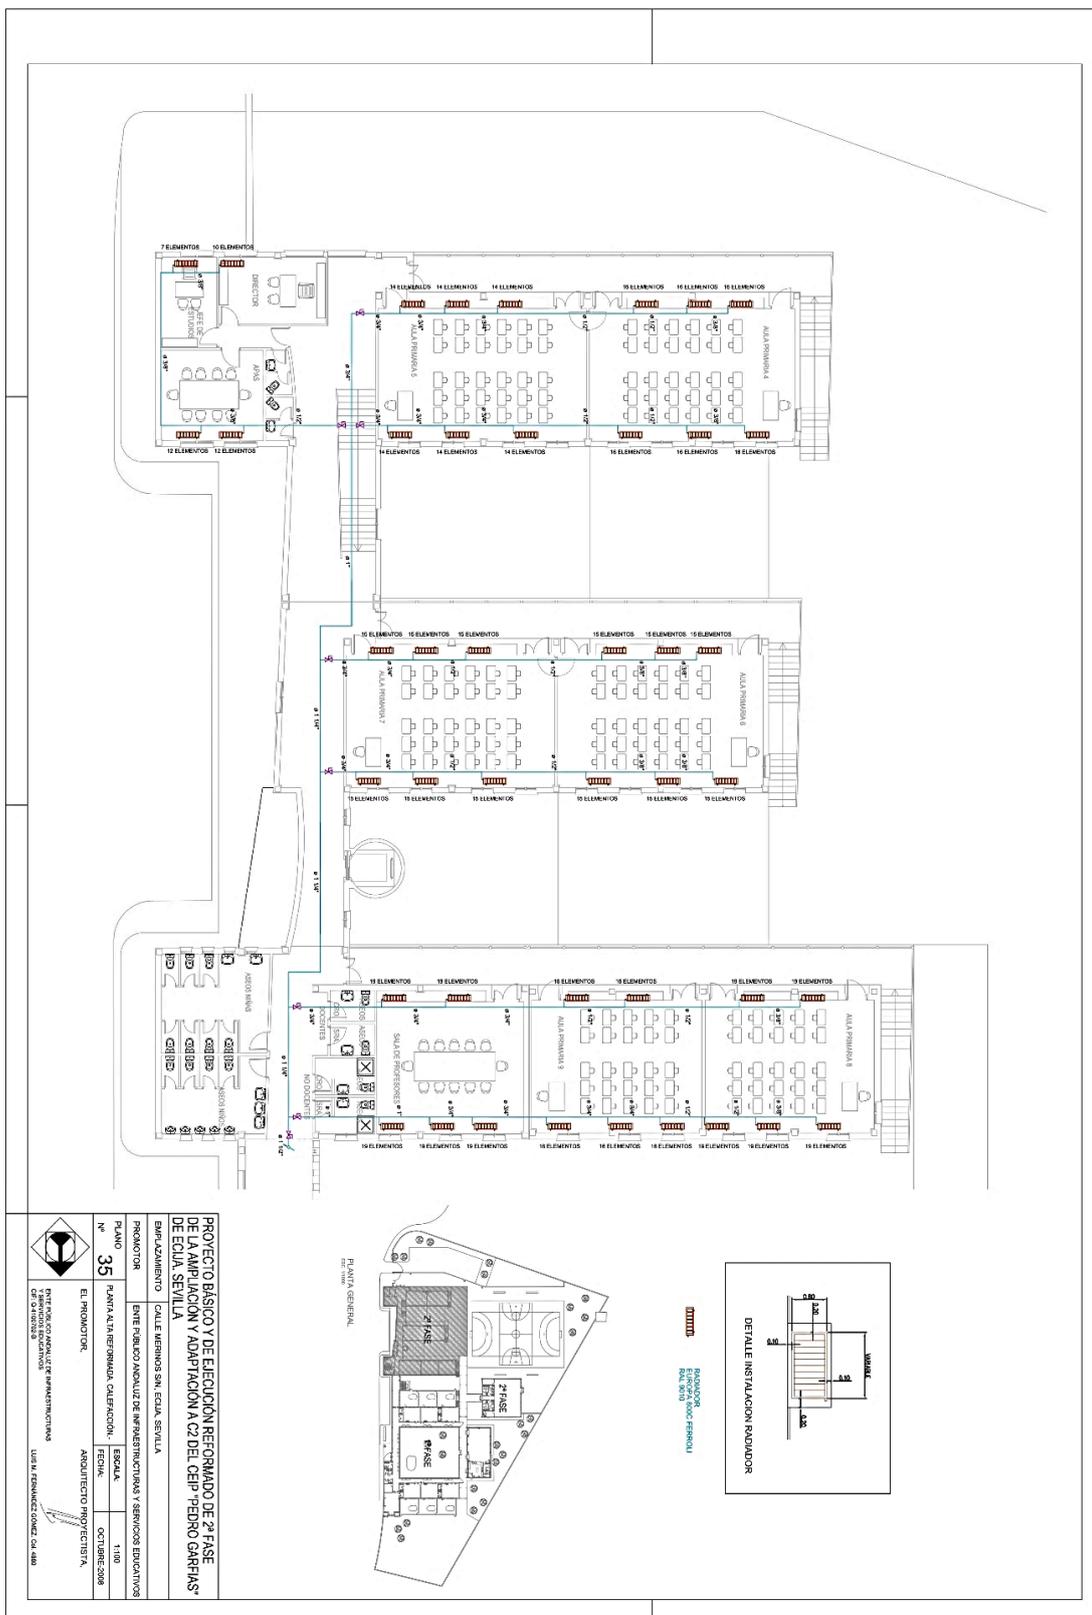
Plano riesgos calefacción Edificio Primaria planta alta
